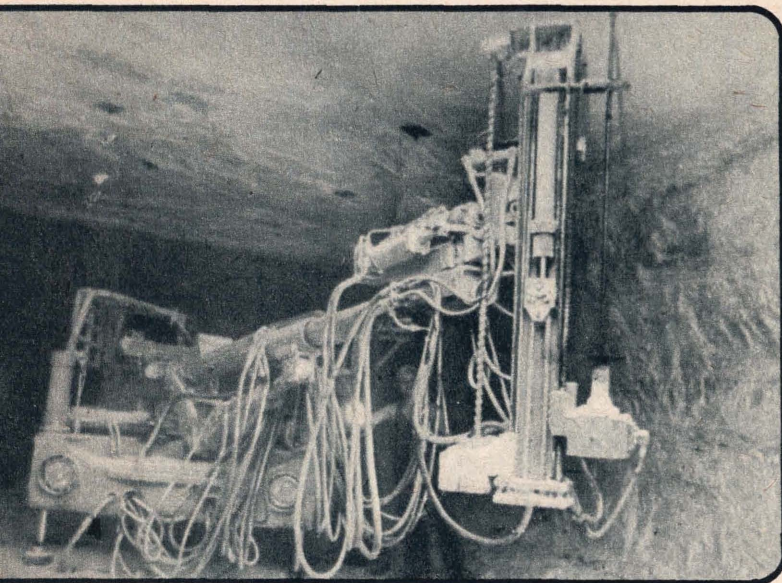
Mit Ankersetzwagen wird die Decke gefestigt; je Schicht werden 60 etwa 1,50 m lange Stahllanker vollmechanisch eingebracht
